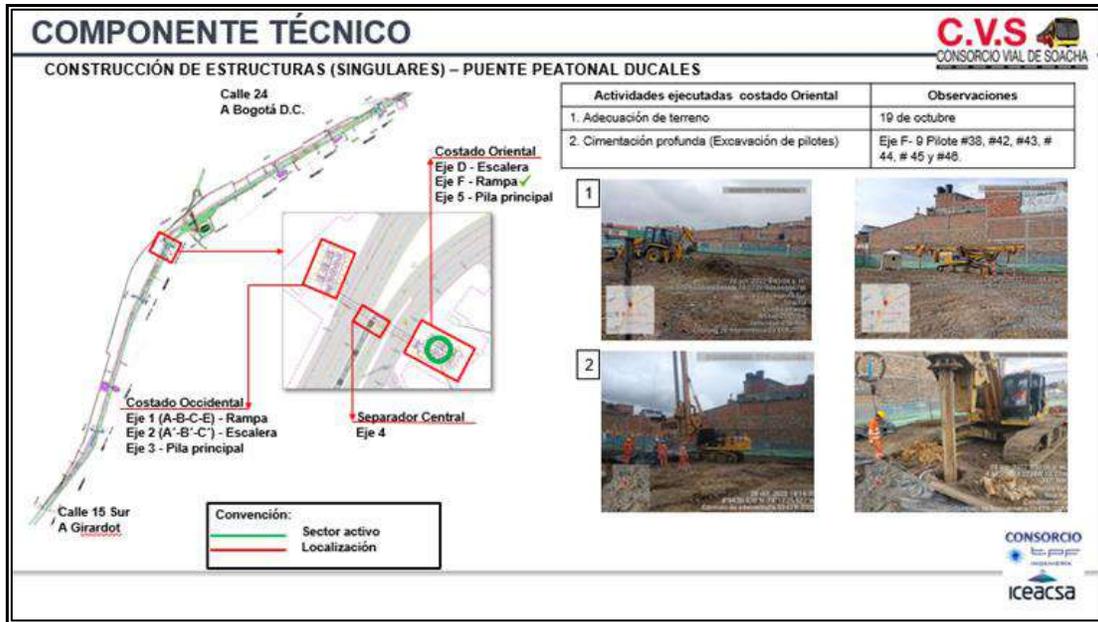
Resumen Construcción Puente Peatonal Ducales
